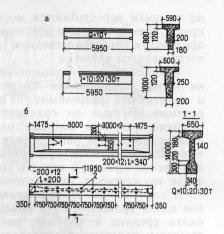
Железобетонные подкрановые балки а — тавровые под краны грузоподъемностью 10-30 т при
